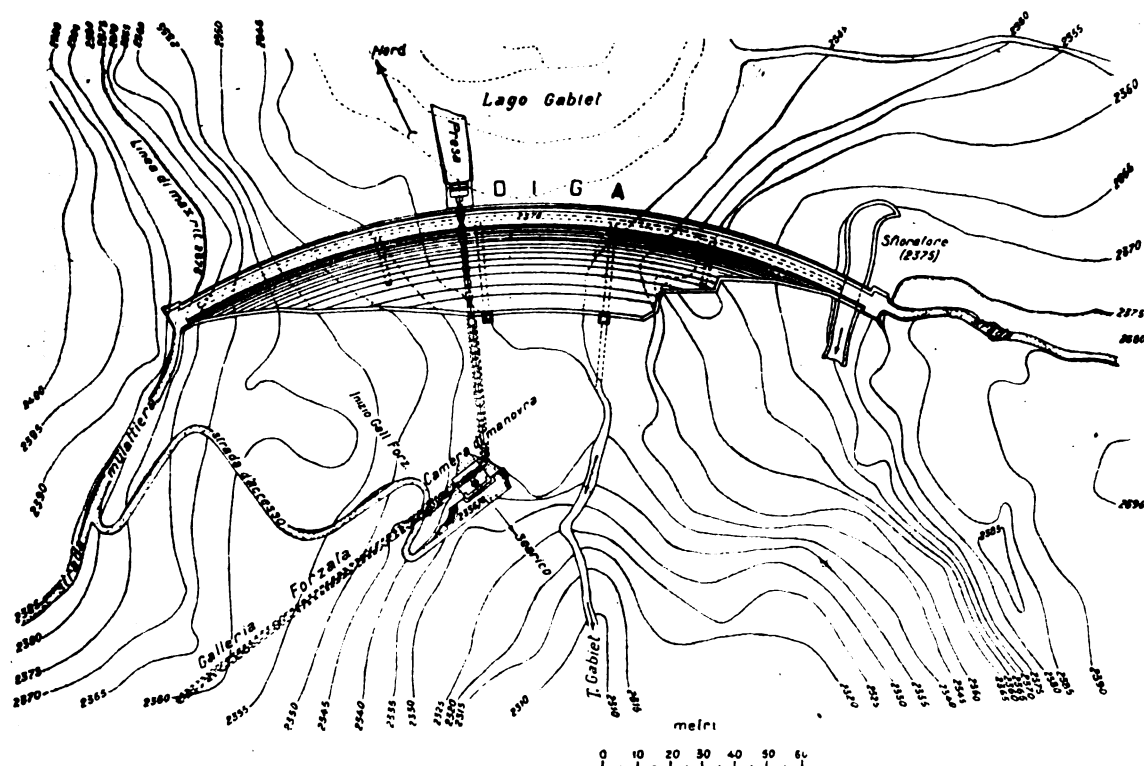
Planimetria generale della diga sud al Lago Gabiet.
